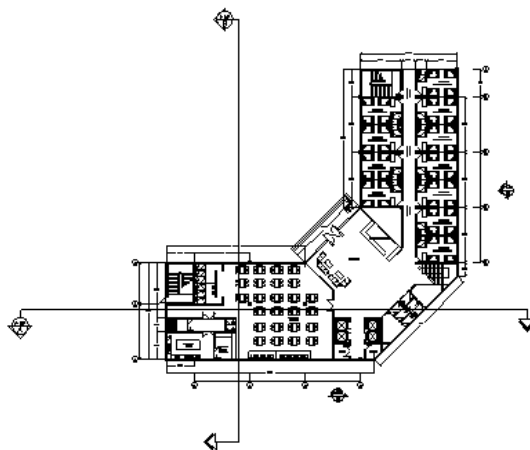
Denah Lt. Dasar Gedung C
